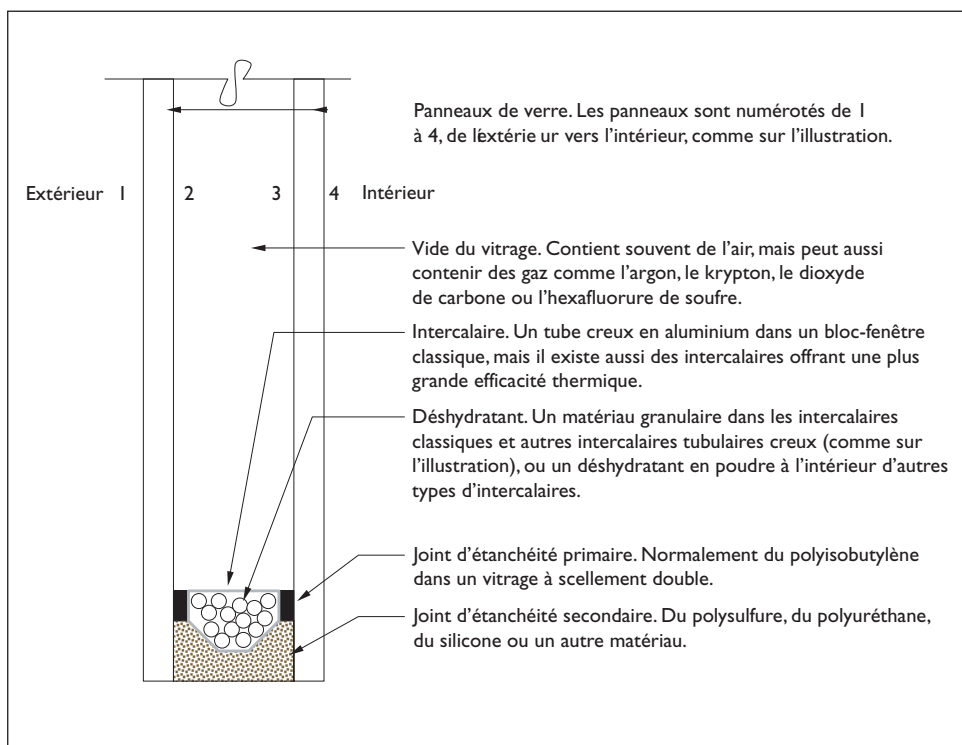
Coupe transversale d'un vitrage isolant caractéristique
